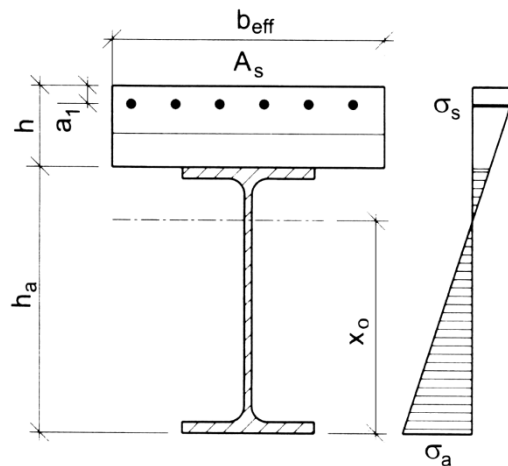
К определению положения нейтральной оси опорного сечения с трещинами в бетонной плите
